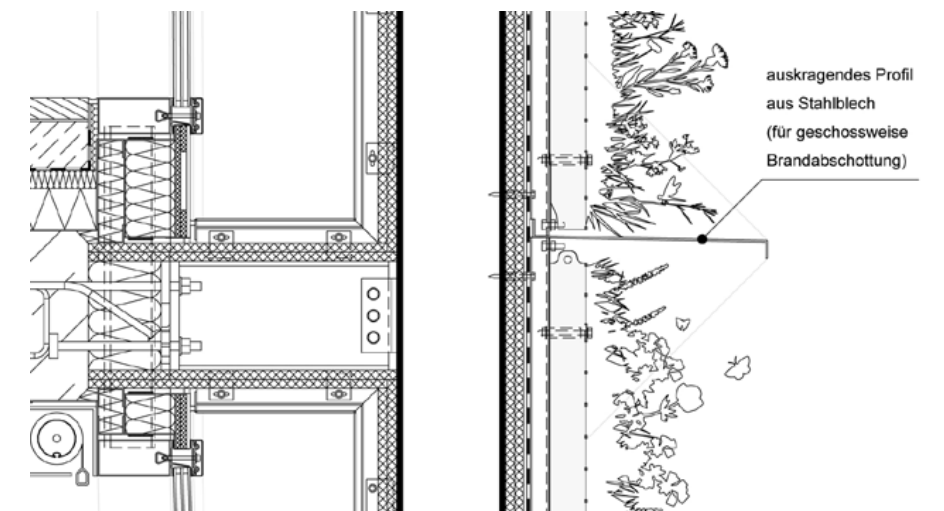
Eigenes Konstruktionsdetail - Brandsperren bei Fassadenbegrünung
